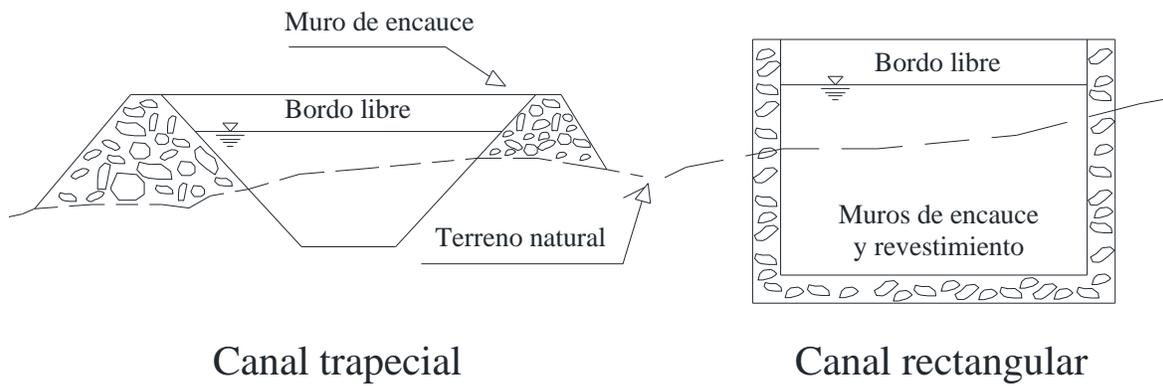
Secciones propuestas para el canal a cielo abierto
